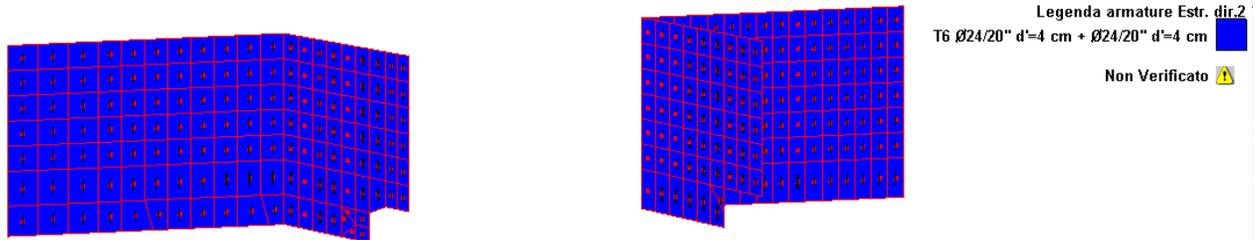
Armatura fusto Spalla di Estradosso ed Intradosso direzione 3
